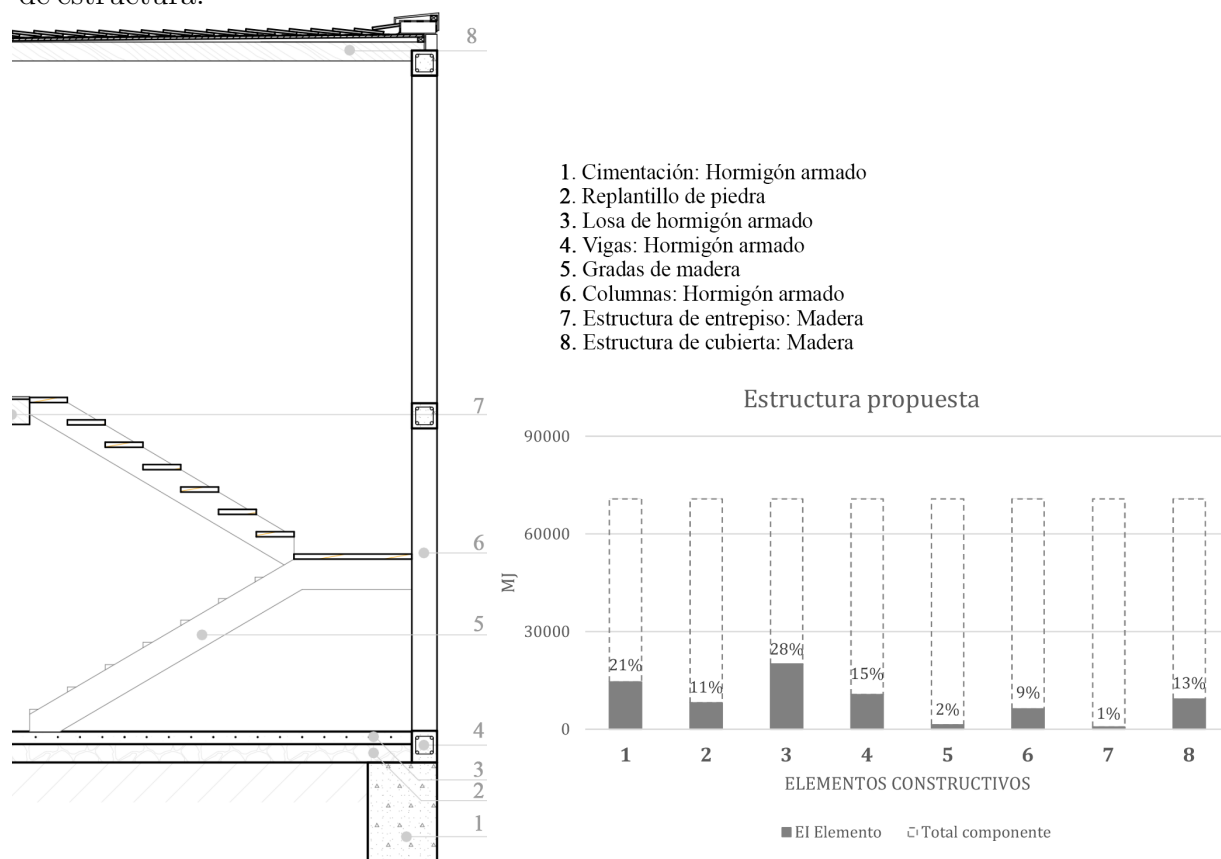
Estructura considerada para la propuesta de vivienda. a) Sección constructiva b) Energía Incorporada requerida por cada uno de los elementos constructivos.
